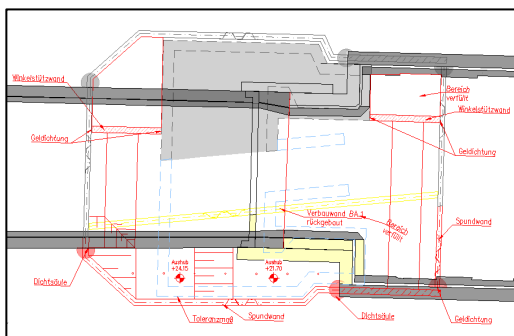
Ausschnitt Plan GuD Zi\_BG-VP 002 Grundriss (unmaßstäblich)
